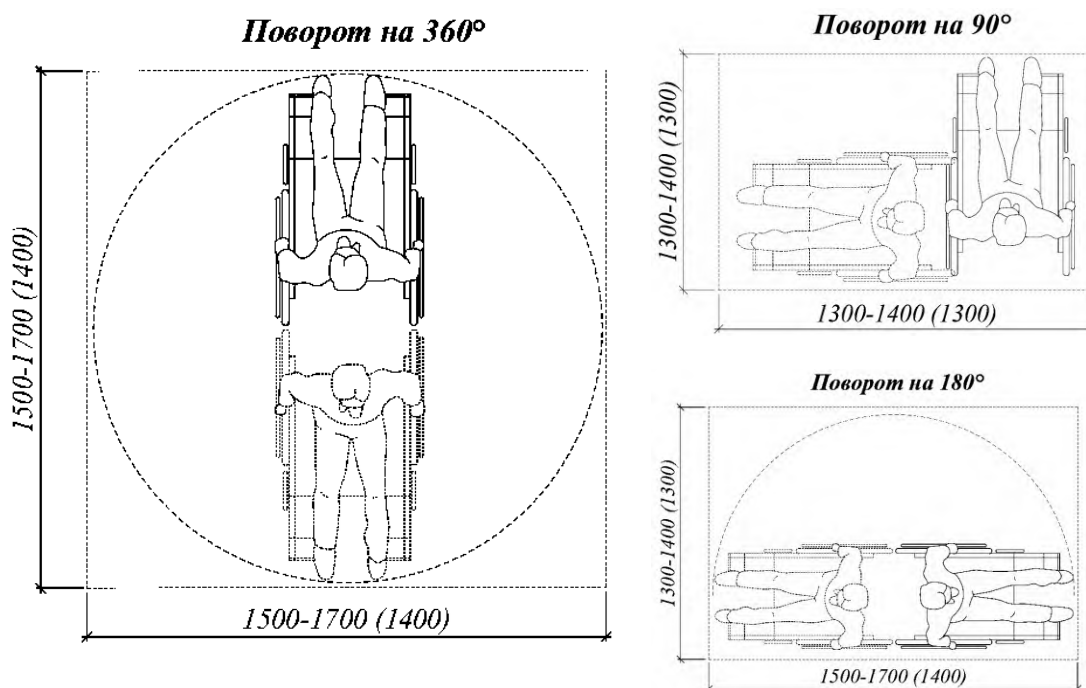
Оптимальные (нормируемые) размеры зон разворота кресла-коляски
